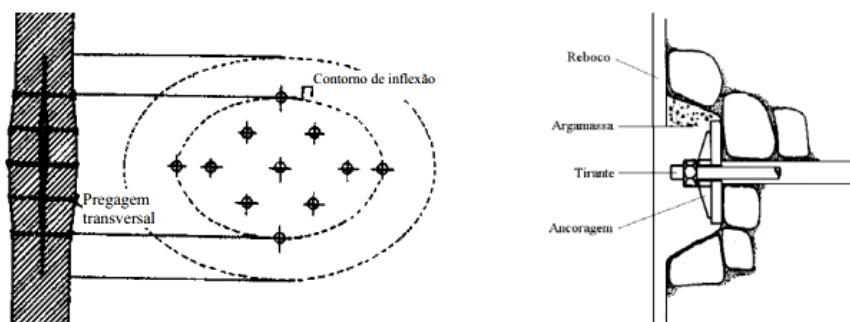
Pregagens transversais e dispositivo de amarração [46]
